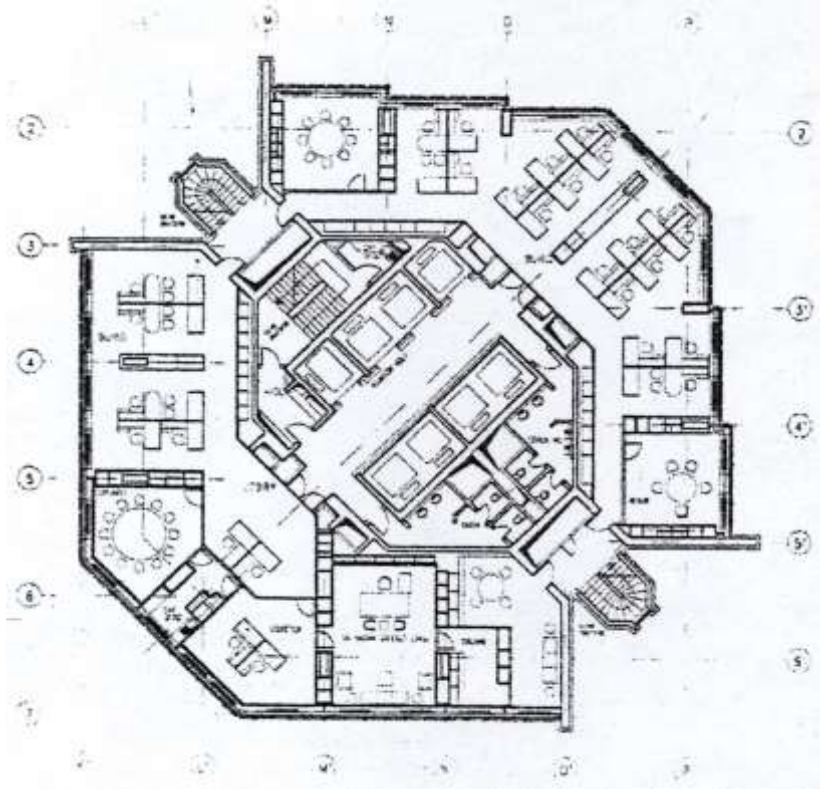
Sabancı Center bodrum kat planı (Tümay, 1992).
